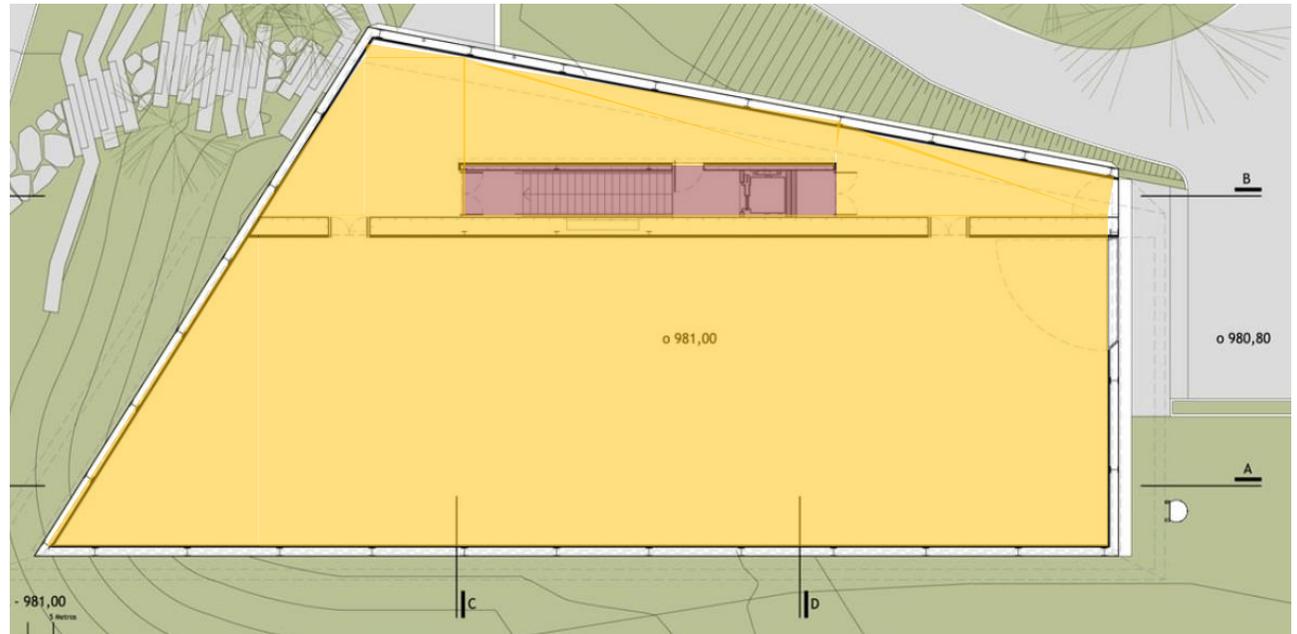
Planta baixa nível intermediário - Fonte: Archdaily D, 2019.
